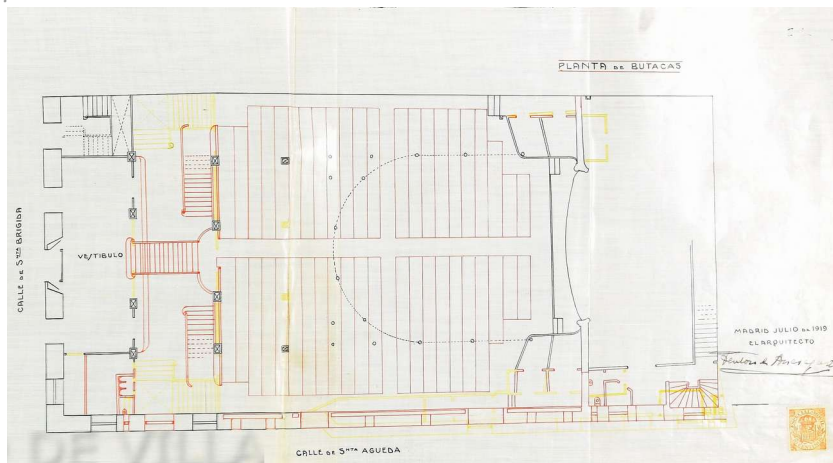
Proyecto de reforma del Teatro Martín (1919). Planta. Fuente: A.V.M. Exp : 22-190-82
